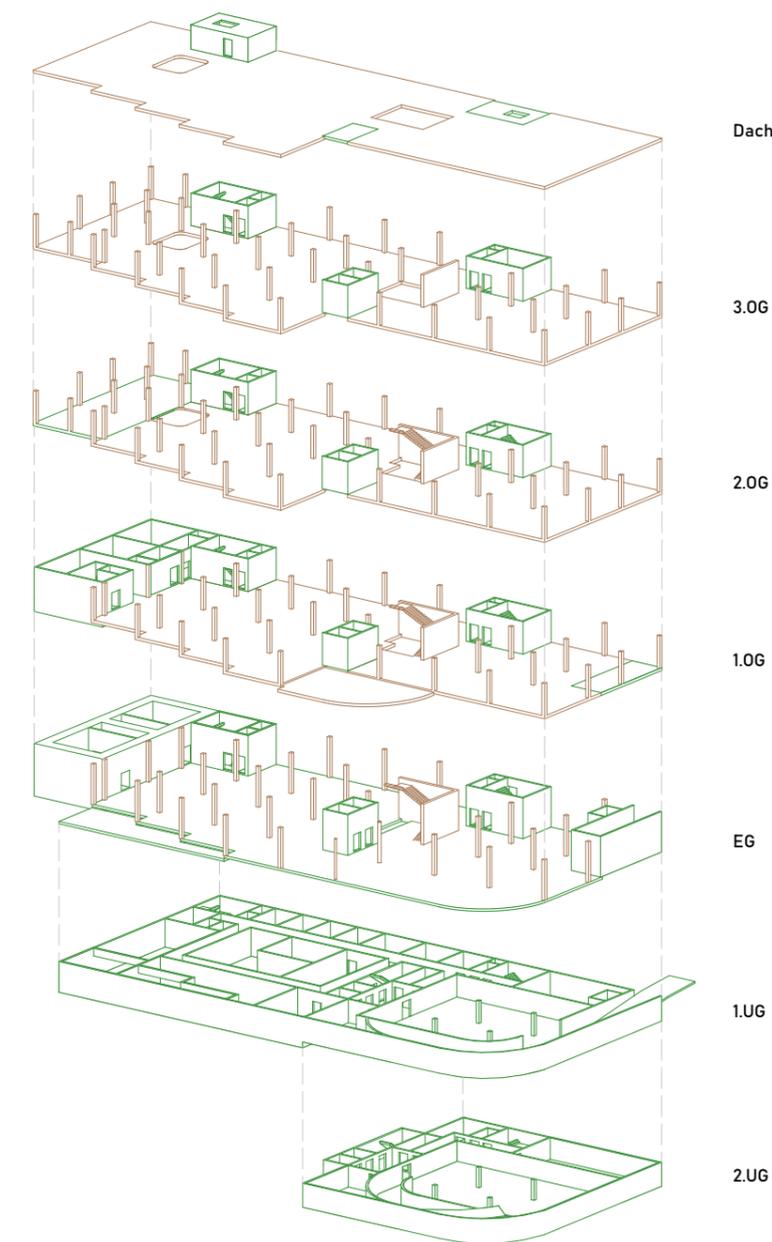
Isometrische Explosionszeichnung des Tragwerks
